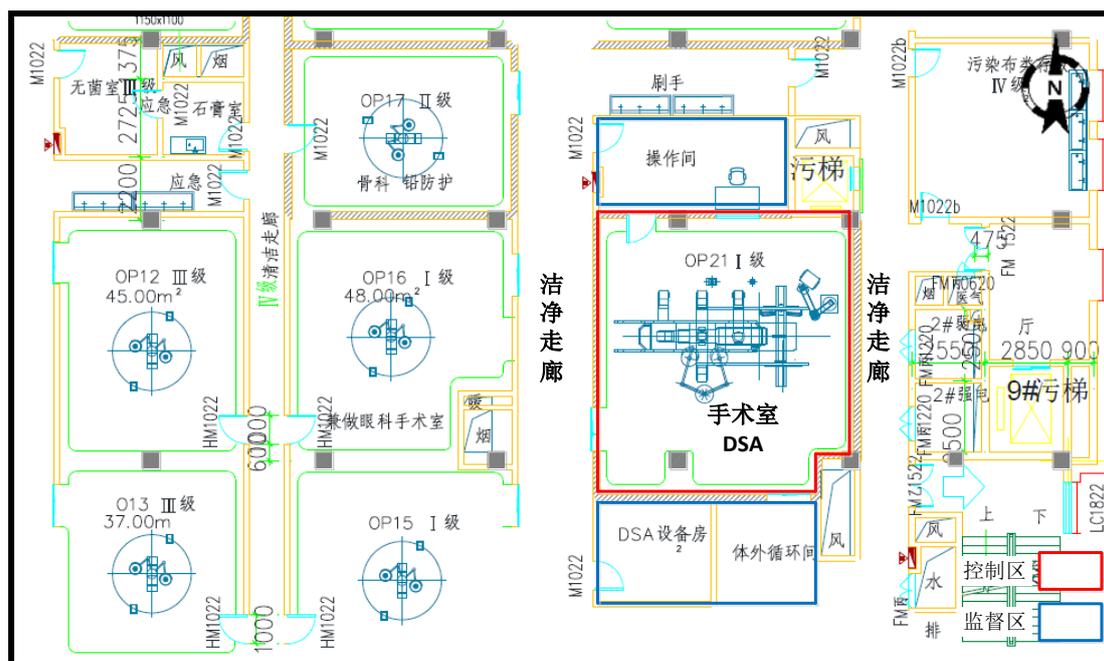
手术室 DSA 工作场所平面布局及辐射防护分区示意图
